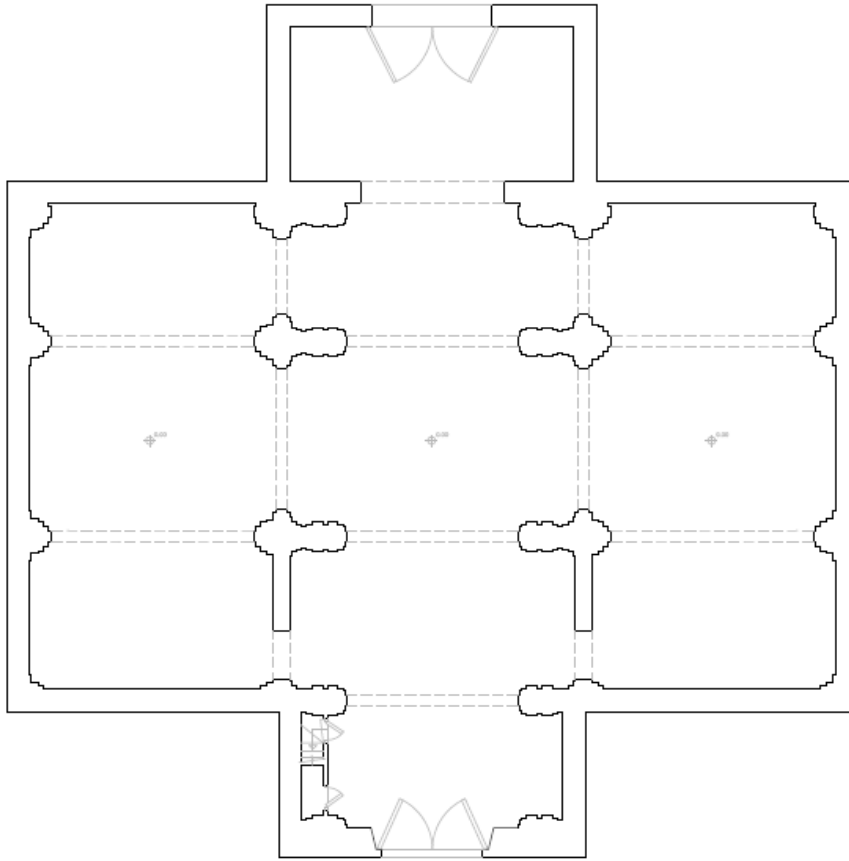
Plano de Planta Baja. Fuente: Universidad de Sevilla
